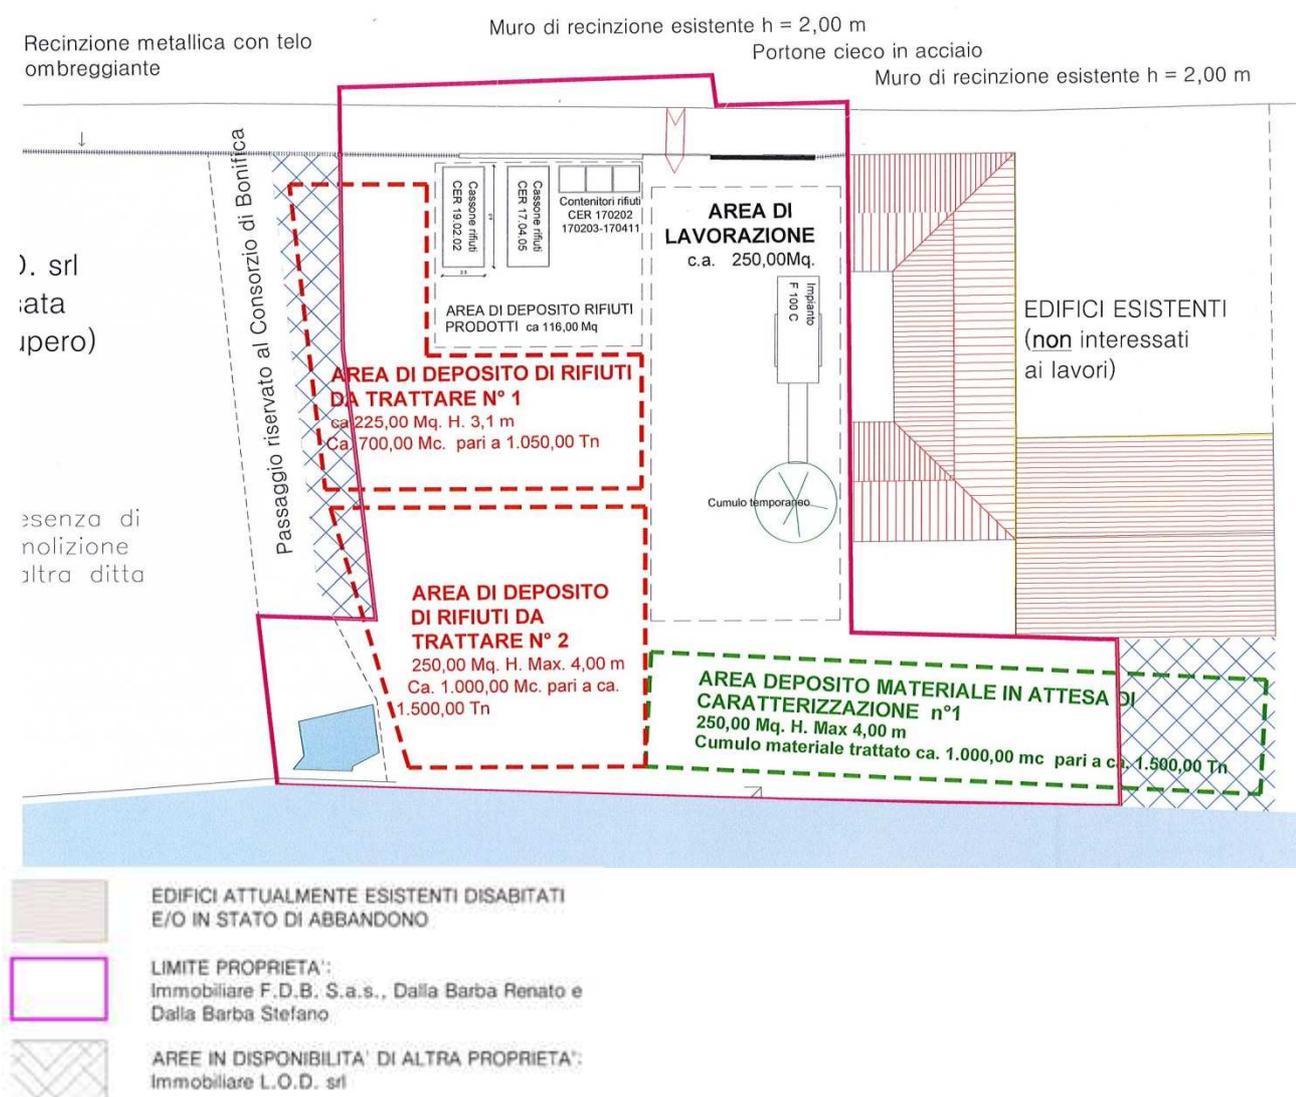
estratto del layout del cantiere, da tavola in Elaborato n.3
